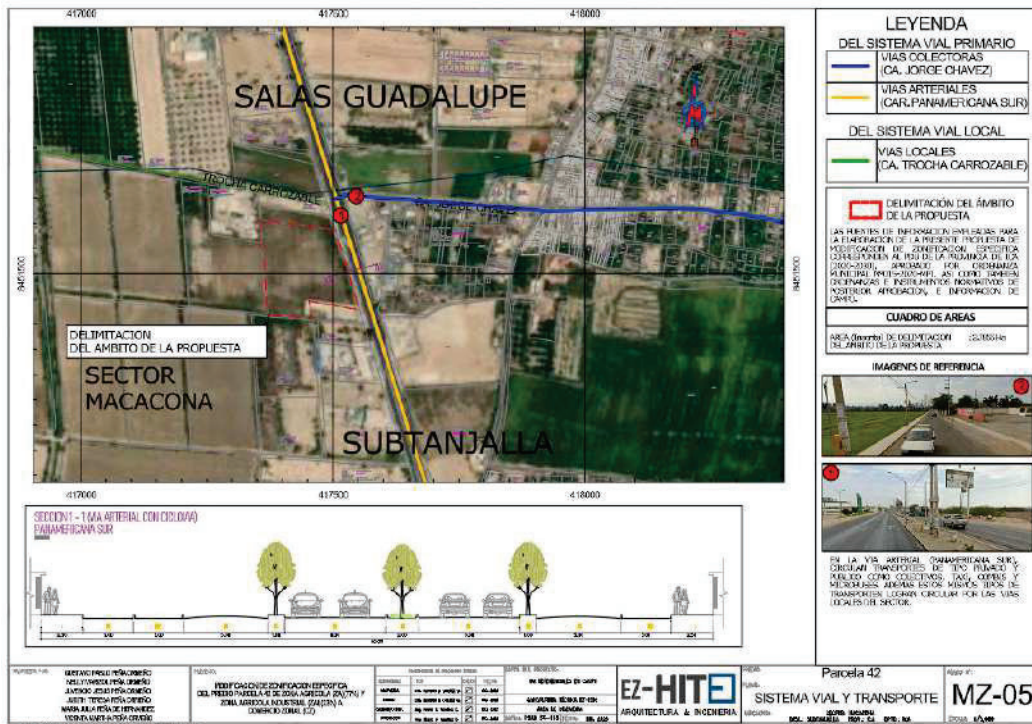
Sistema Vial; Lamina MZ-05.
